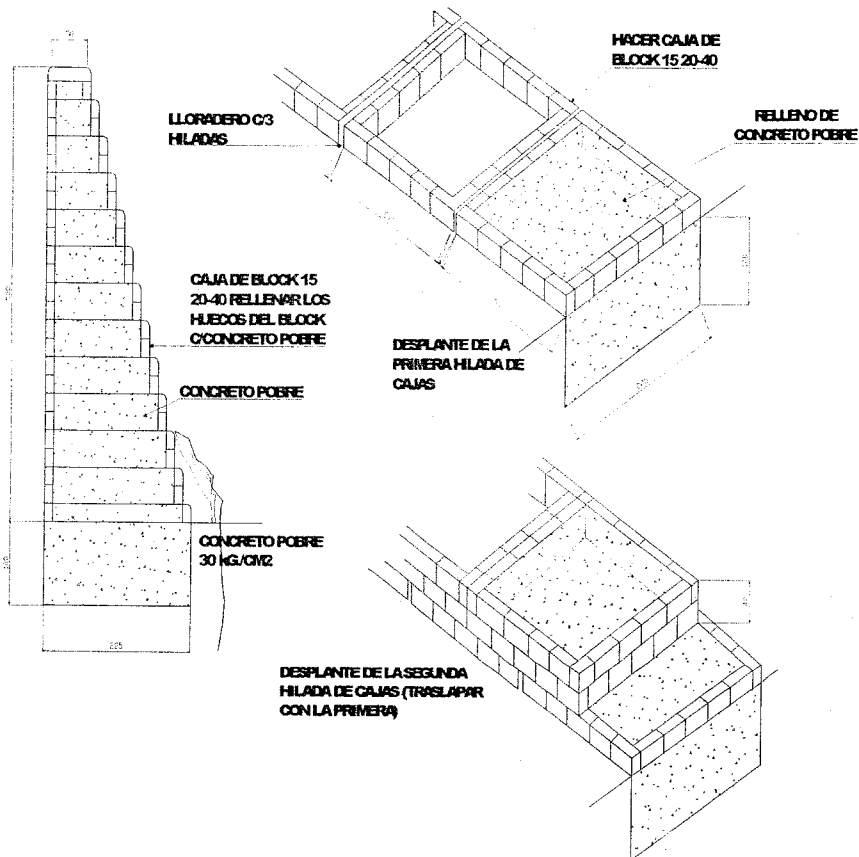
MURO TIPO LOBATON PARA LA BARRANCA 7.
